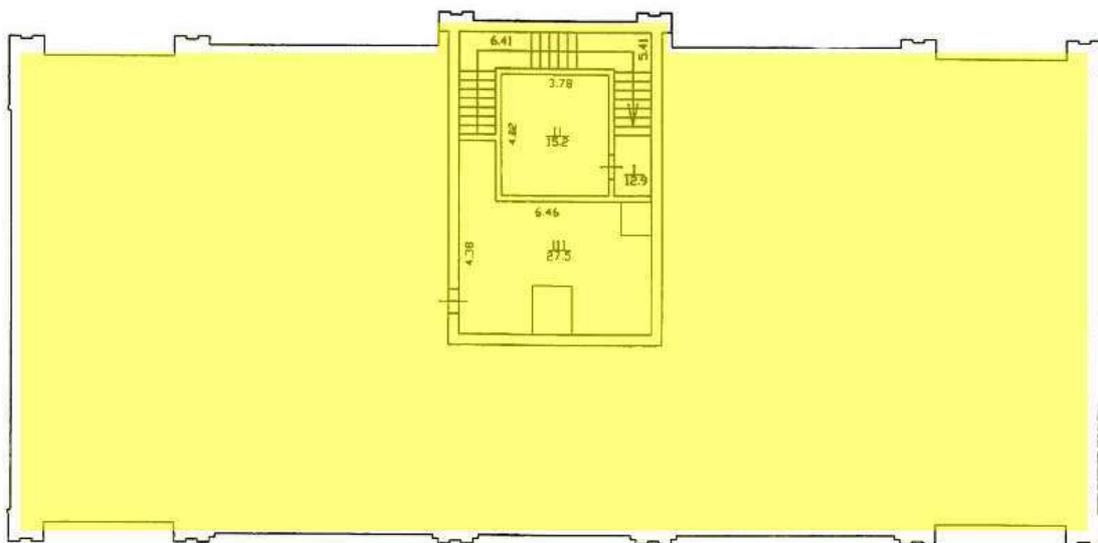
План 7-го поверху. Технічний поверх
